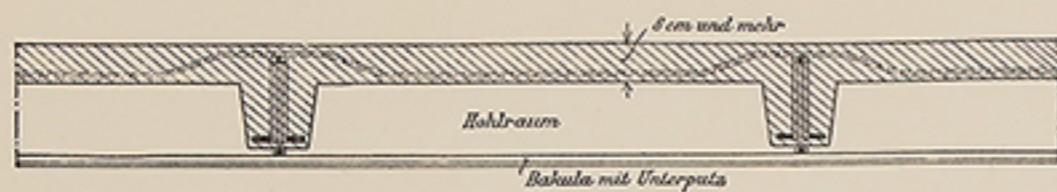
Aufgestellte Eisenbetondecke zwischen Betonbalken mit Einlagen aus nietlosen Gitterträgern.
